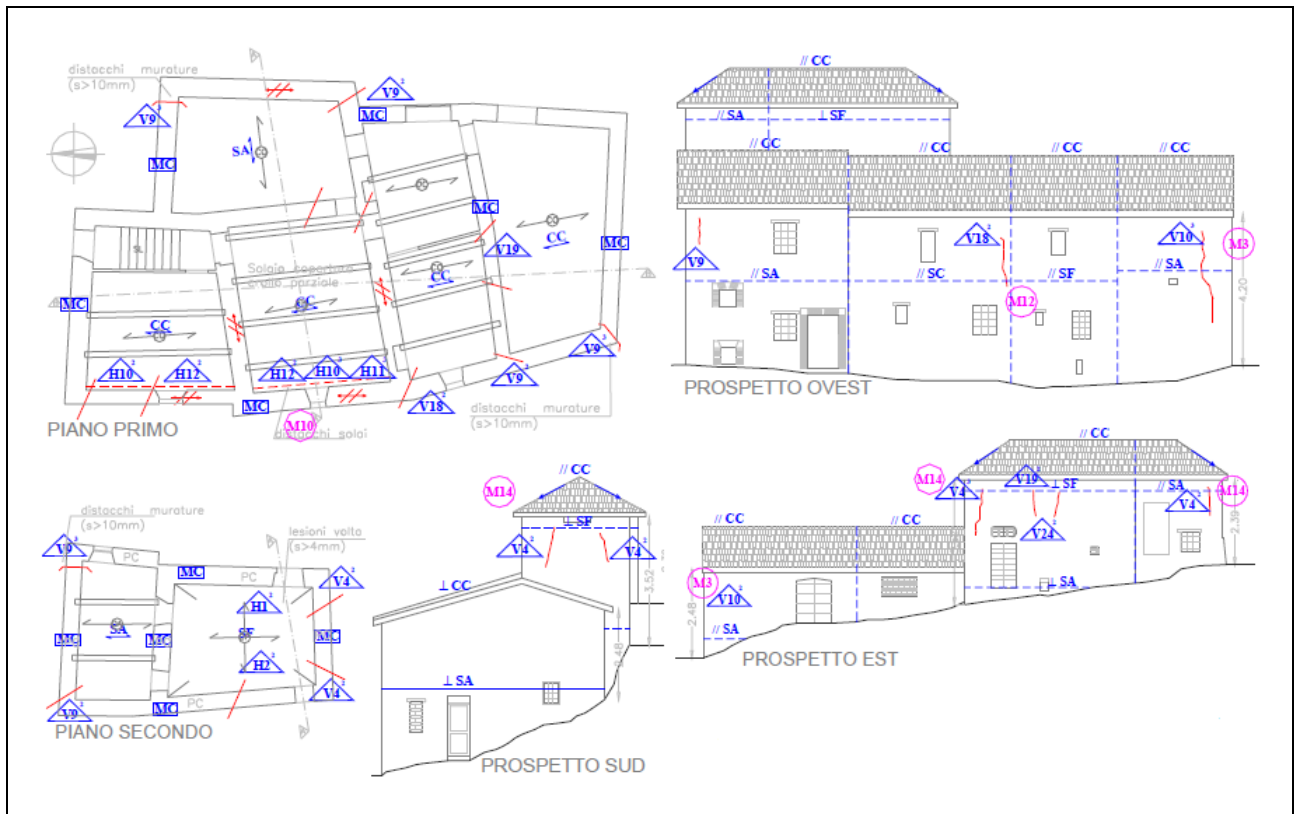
Dall'alto, in senso orario: pianta del piano primo, prospetto ovest, prospetto est, prospetto sud, pianta del piano secondo dell'edificio
